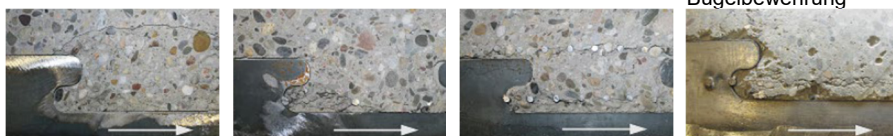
Darstellung der Rissentwicklung im ersten Betondübel von oben in den Push-Out Versuchen von Gajda nach dem Aufschneiden [63]
